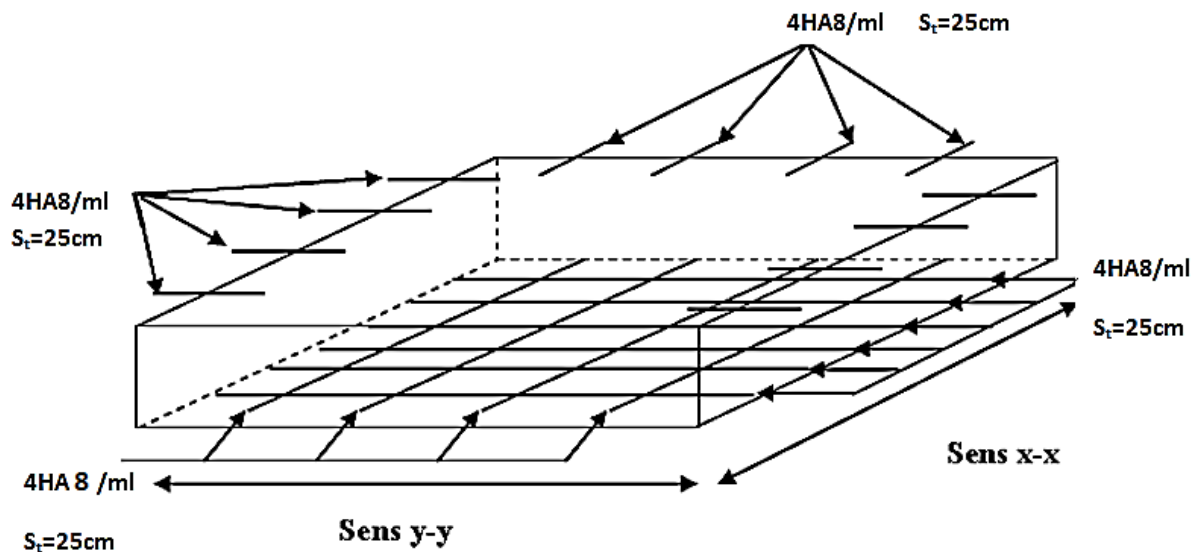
Schéma de ferrailage de la dalle sur 2 appuis
